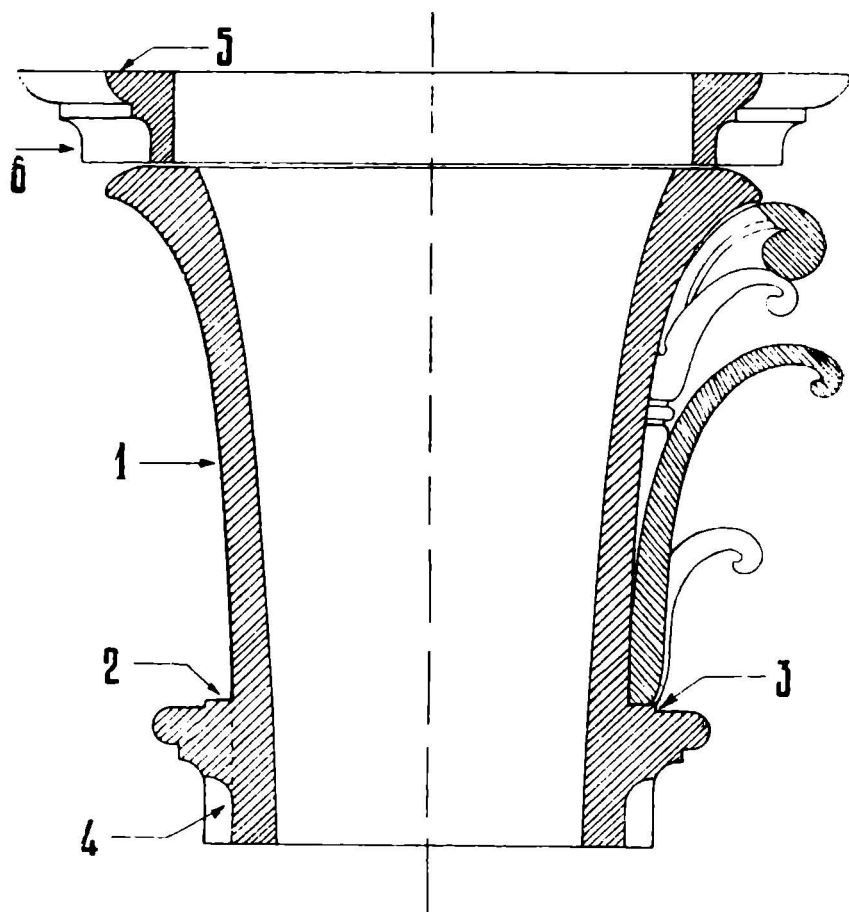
Разрез коринфской капители. 1 — профиль тела капители для шаблона, 2 — уступ установки листьев, 3 — контрольный уступчик, 4 — глубина капелюры, 5 — основной профиль абака, 6 — угловой профиль абака
